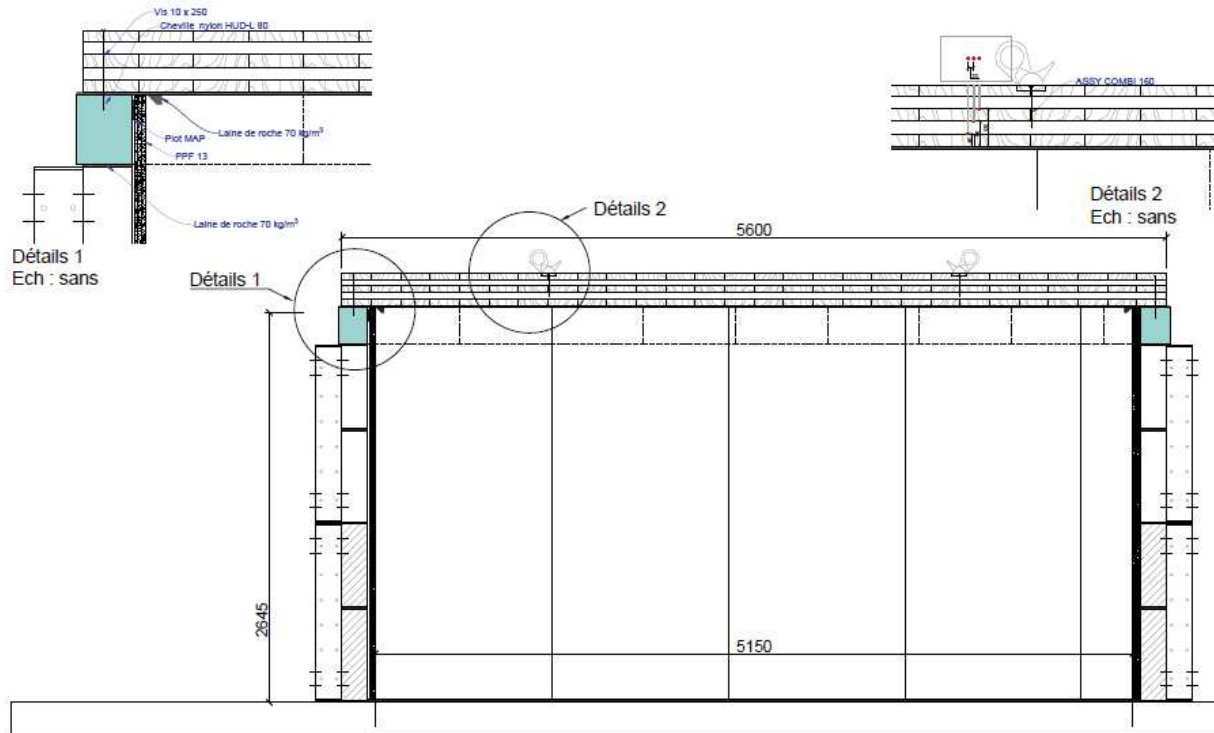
Coupe AA de la cellule d'essai pour les essais 2 et 4 (plafond CLT)
